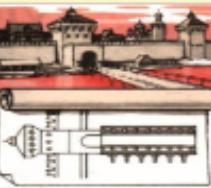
Креслення моста і сторожової вежі XVII століття. План та фасад смузичні
